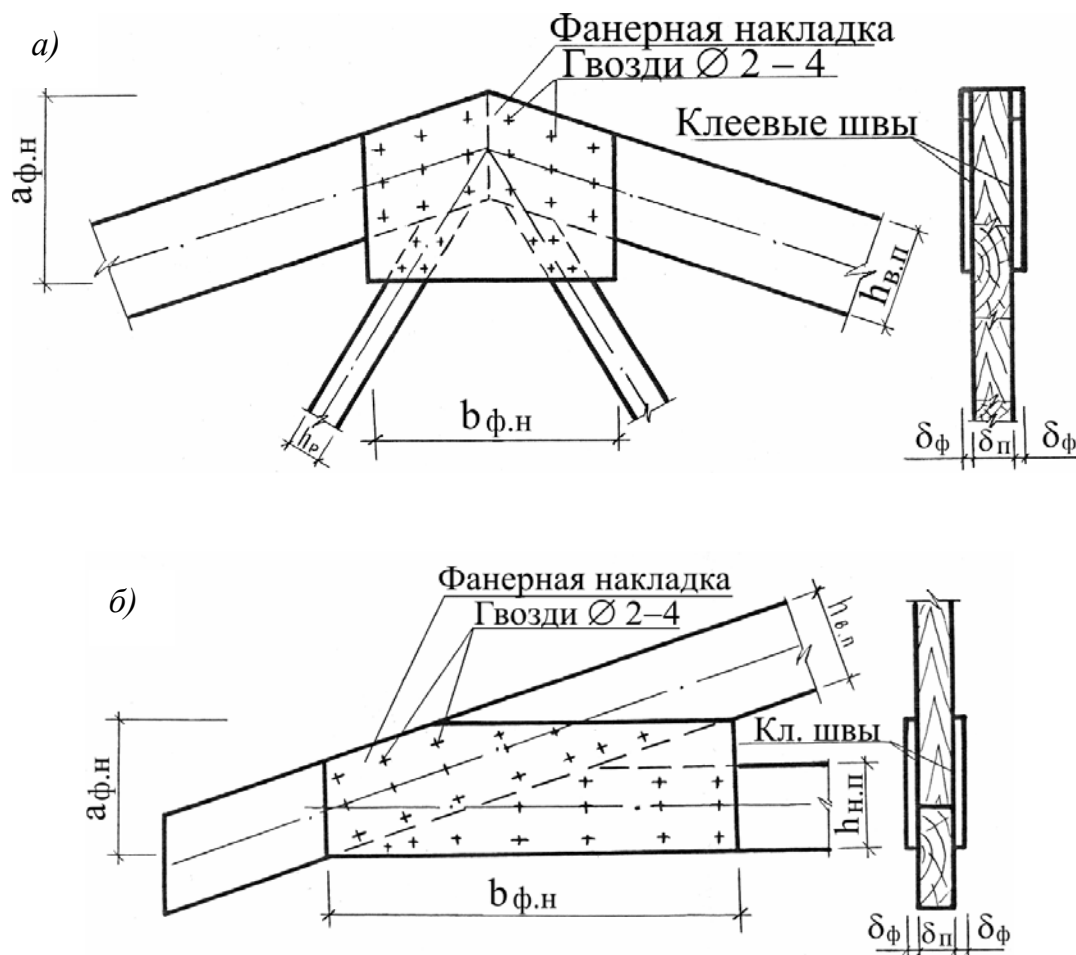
Узлы ферм на фанерных накладках: а – коньковый; б – опорный
